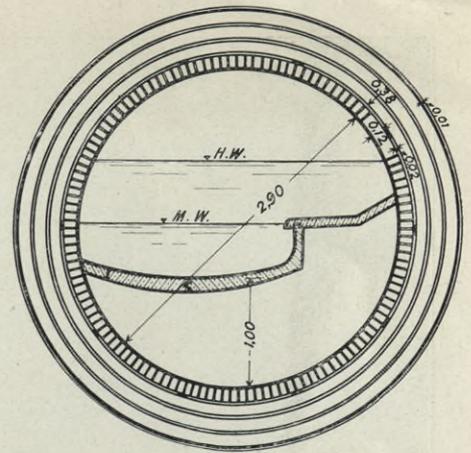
Querschnitt eines Bachlaufes, der als geschlossener Kanal in Tunnelbauweise hergestellt wird. Diese Ausführungsweise hat wiederholt unter Bahnanlagen, Bergehalten, Kolonien und dem Schifffahrtskanal angewandt werden müssen und ist meist in Beton mit Schildvortrieb und unter Anwendung von Preßluft durchgeführt. Hier ist die Ausführung in Ziegelmauerwerk mit einem inneren Ringe aus Verblenden dargestellt. Die Sohle kann beim Eintritt ungleichmäßiger Bodensenkungen tiefer gelegt werden. Im ganzen sind bisher über 2600 m neue Bachkanäle in Tunnelbauweise hergestellt, die meisten davon mit Schildvortrieb und Preßluft.
